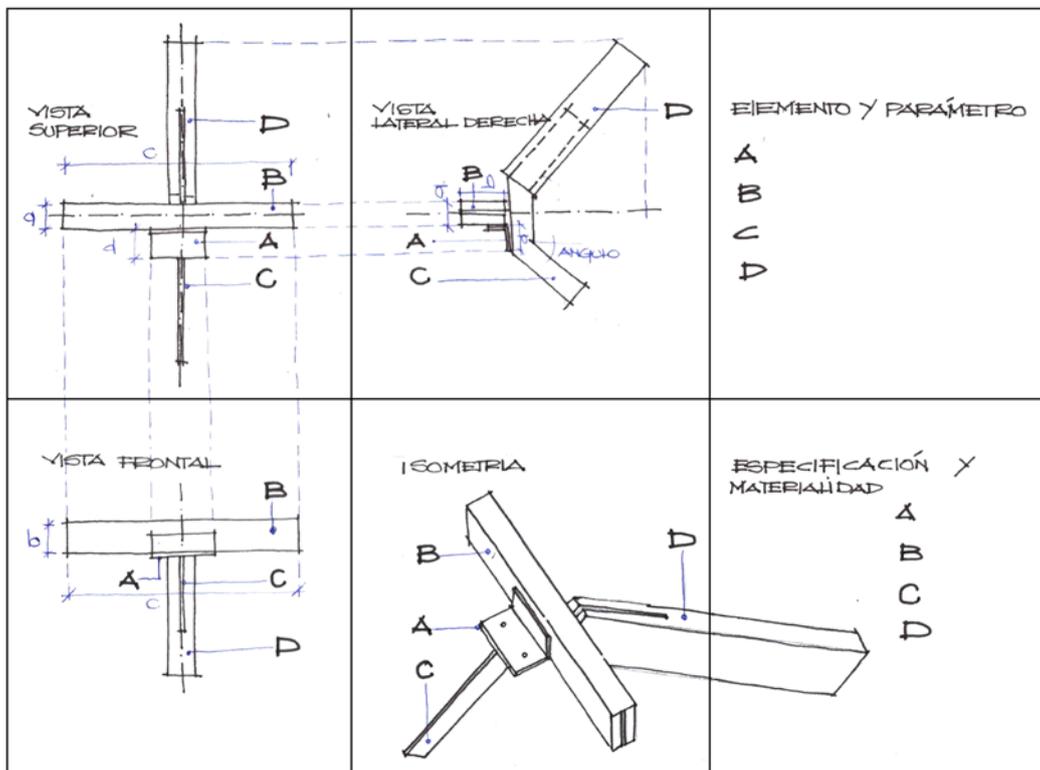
Definición Conexión Estructural Acero – Madera en la Matriz de Diseño. Elaboración Propia
